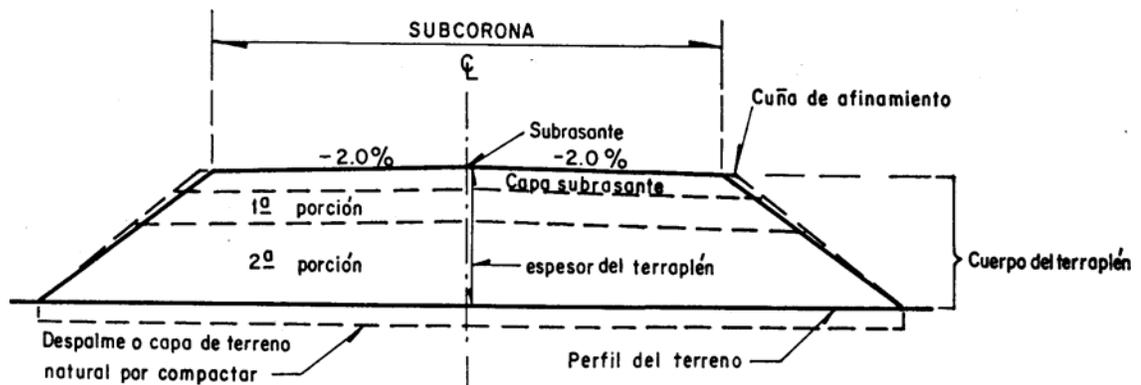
Sección de Construcción de un Terraplén en Tangente
